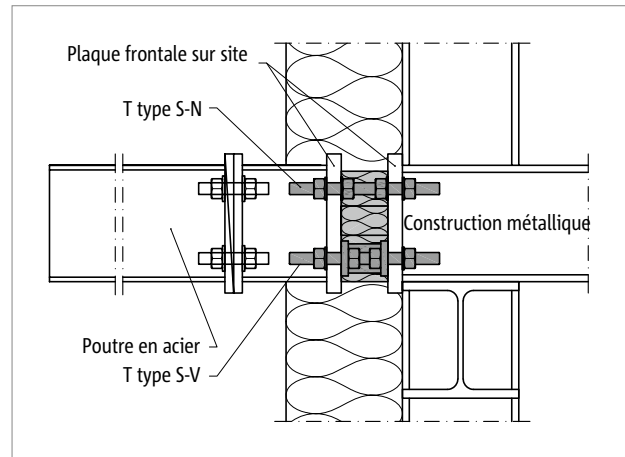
Schöck Isokorb® T type S-N et T type S-V : construction en acier en porte-à-faux libre ; adaptateur sur site
